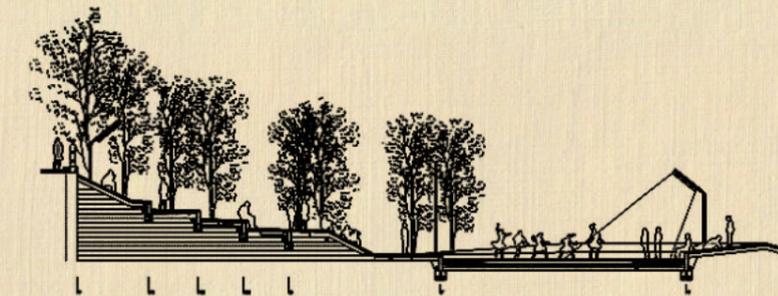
Corte da Praça San Martín, Santander - Espanha.
